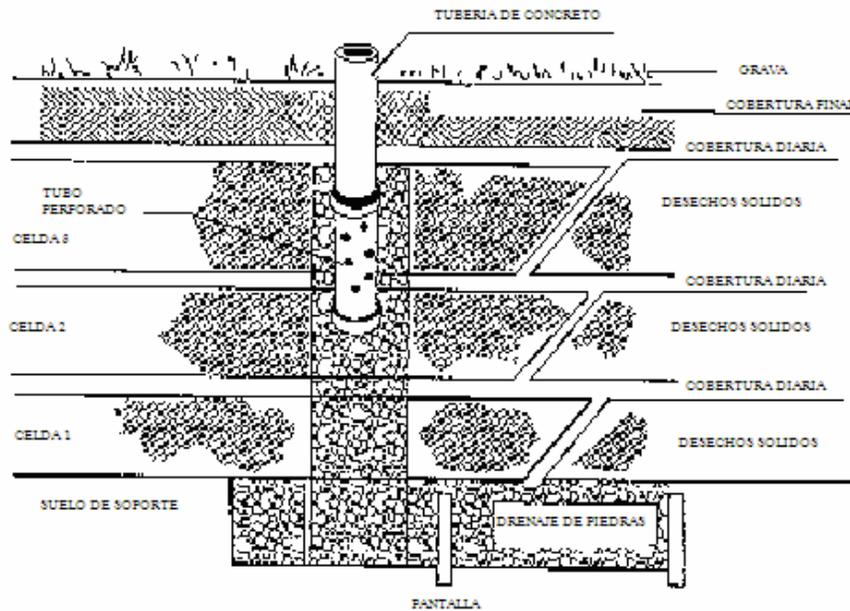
Detalle constructivo del filtro para drenaje de gases
